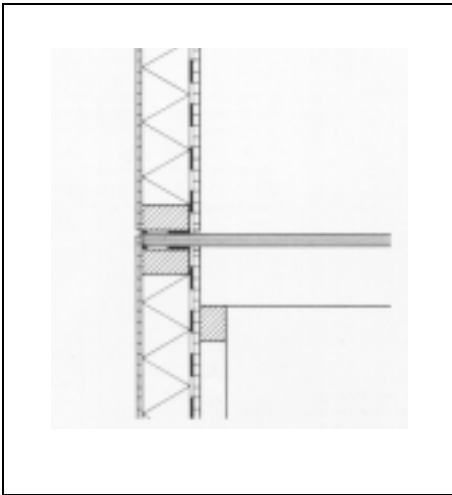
Plattformbauweise - Deckenkonstruktion innenseitig an der Wandkonstruktion befestigt
